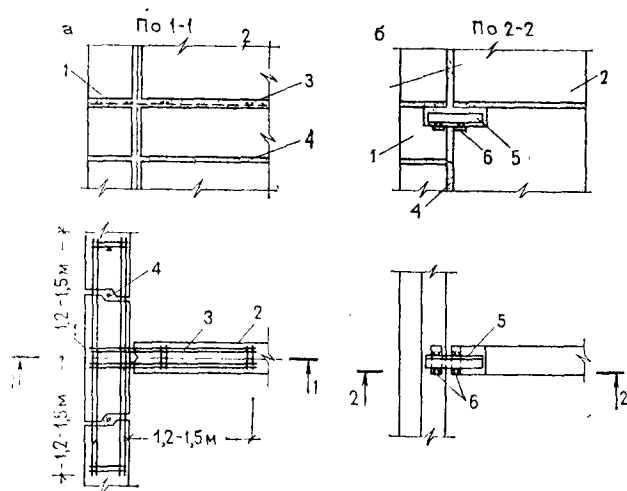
Связи наружных крупноблочных стен с внутренними стенами
